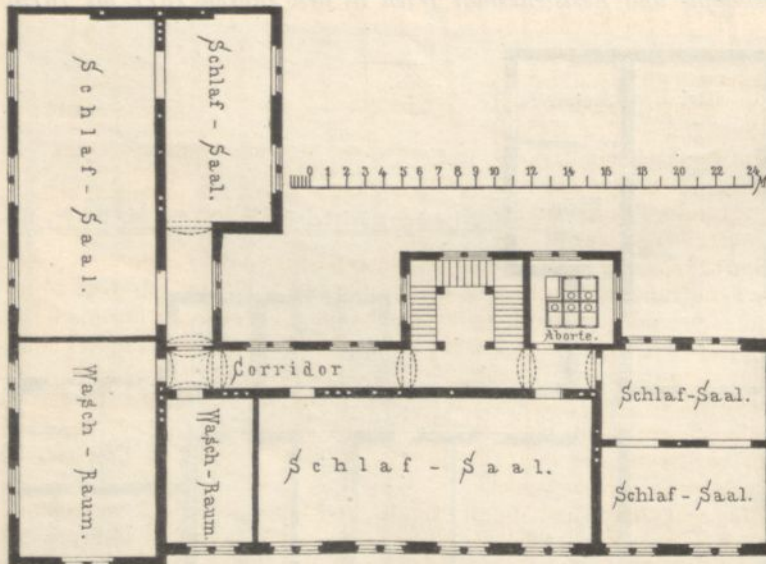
II. Stock des Waisenhauses im X. Bezirke zu Wien.
